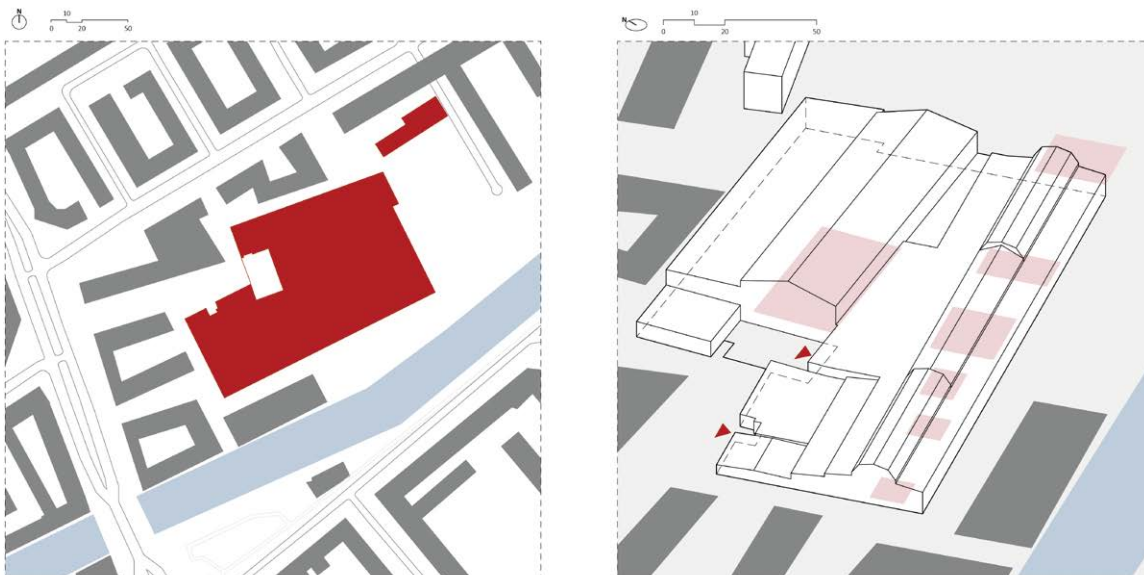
Kampnagel Hamburg, Jarrestraße 20, Lageplan und Isometrie mit Spielorten
